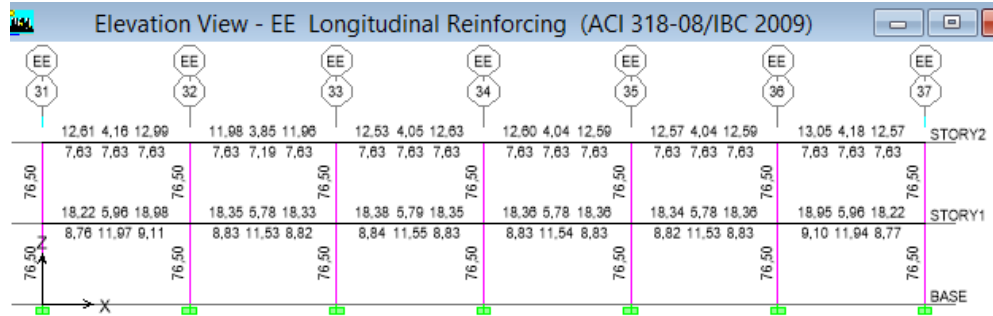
Acero en Vigas y Columnas en el Pórtico EE– Obstetricia - (CEC2002)
